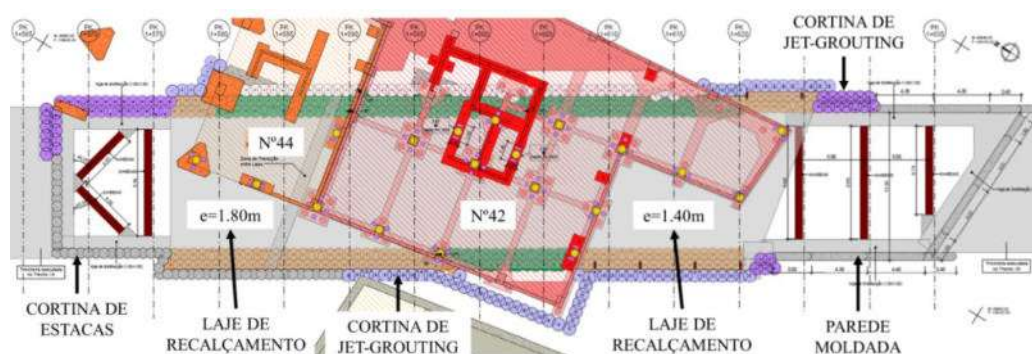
Vista em planta: Solução de escavação cut & cover e escoramento provisório.
